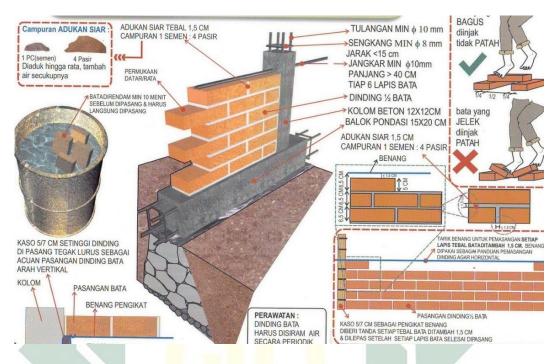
Detail Pondasi Bangunan Agrowisata
